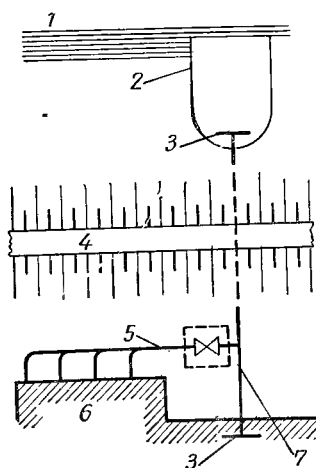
Схема узла насосной станции, расположенной перед дамбой, с совмещением напорного трубопровода с самотечным сбросом:
